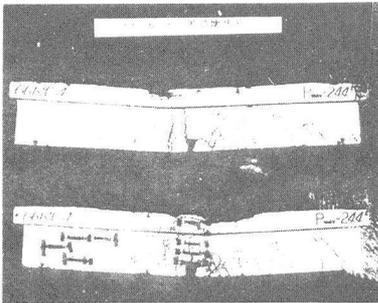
は一般常用配筋ばりの破壊状況であり、写真-2 は傾斜スターラップに特殊配筋ばりの破壊状況の一例である。これで見ると、傾斜スターラップばりは、一般に常用配筋ばりと比較してひびわれがはり全体に分布しており、応力の配分が比較的よいことを示している。
